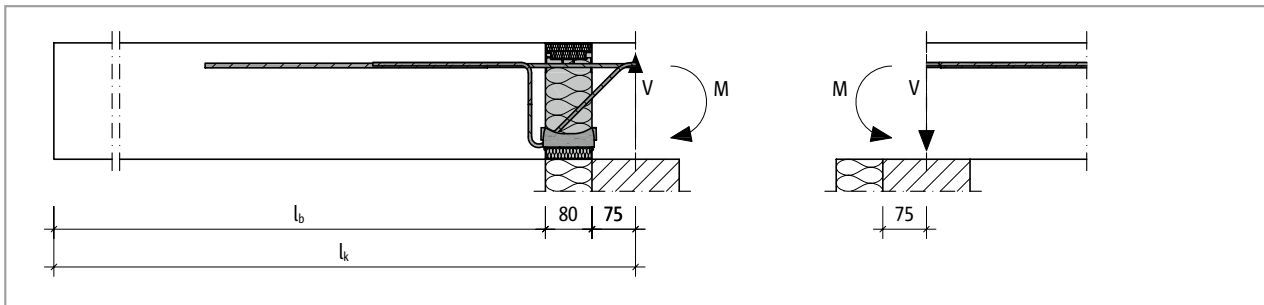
Schöck Isokorb® T tipo K: Esfuerzos internos determinados en cálculo aplicados a la losa
